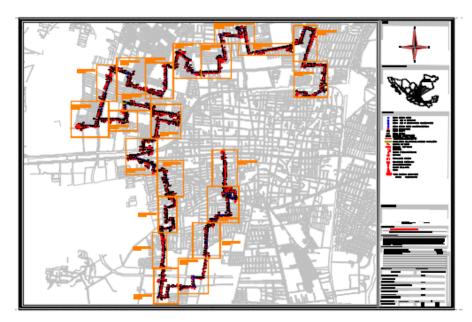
FIGURA DE UN PLANO LLAVE ELABORADO EN AUTOCAD Fuente: Elaboración propia
